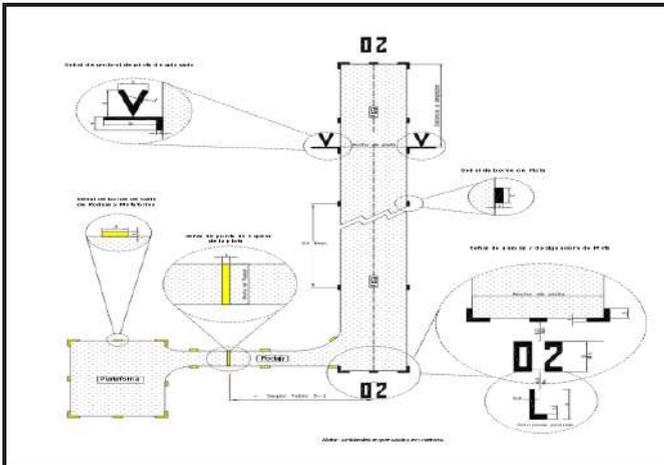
CONFIGURACION DE SEÑALES PARA PISTAS NO PAVIMENTADAS
